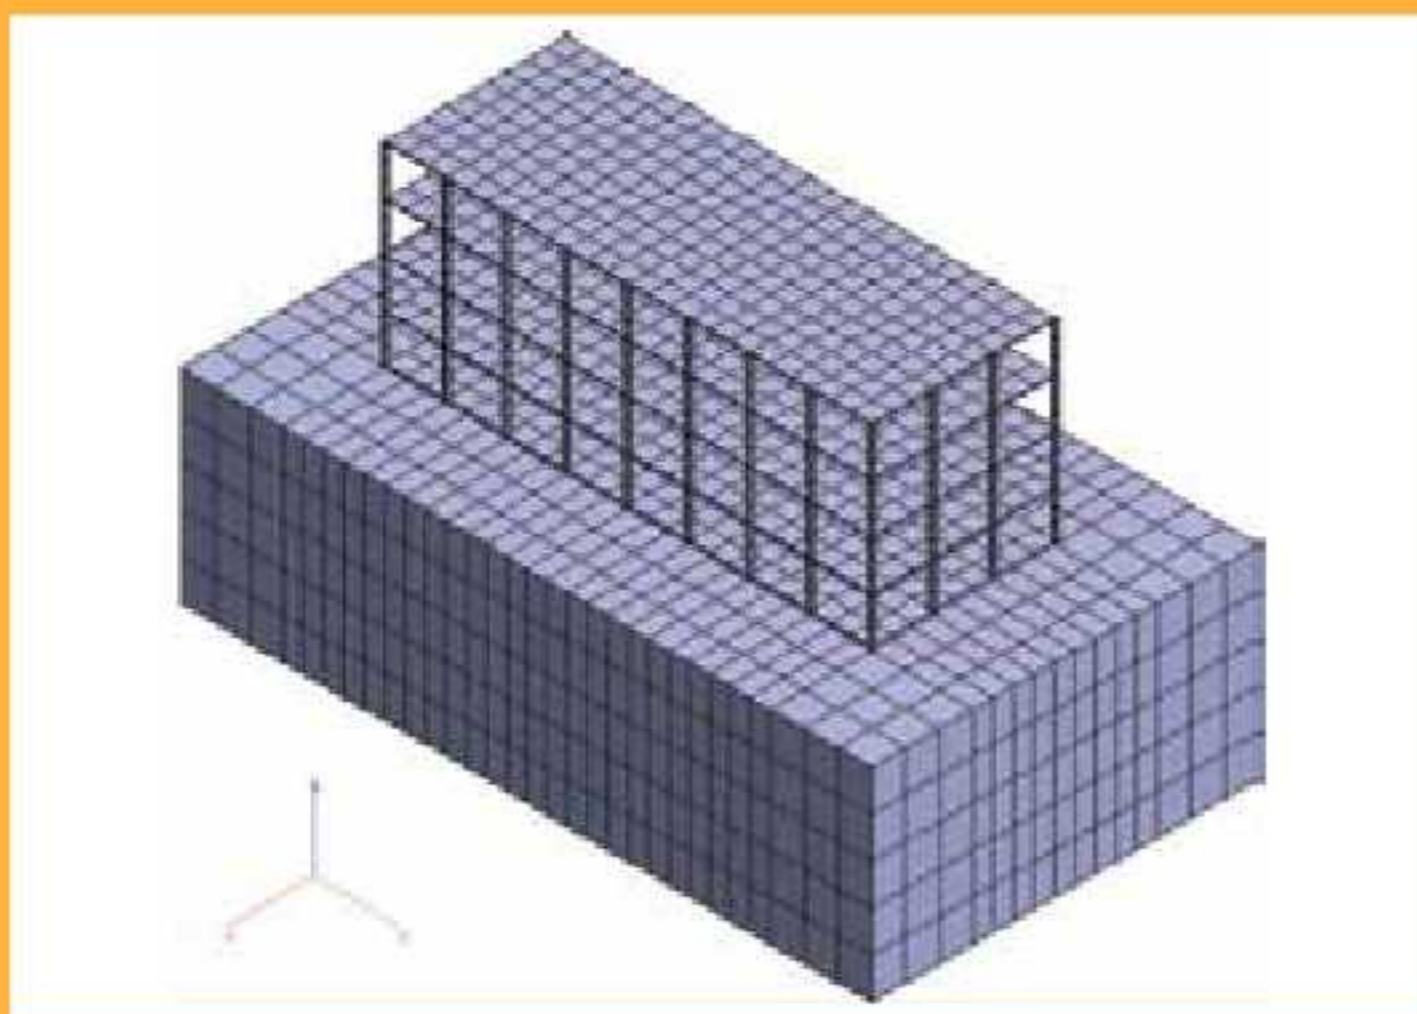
Скінченно-елементна модель промислової будівлі як системи «основа – фундамент – будівля»
